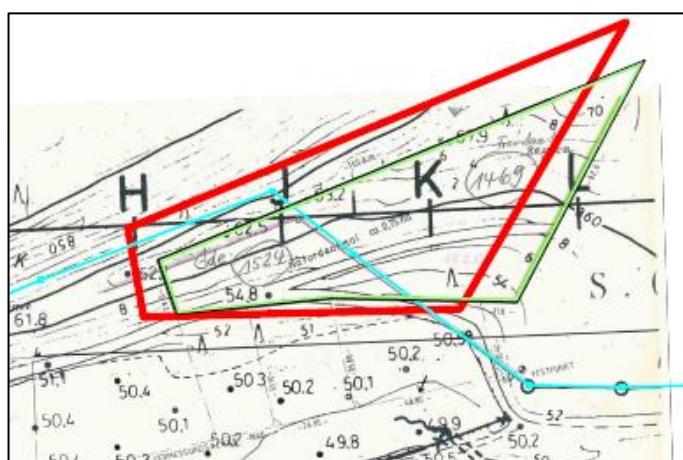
Flächengrenze gem. Lageplan in Verordnung (rot, Grenze 2) und bemaßtem Lageplan (grün, Grenze 3)
